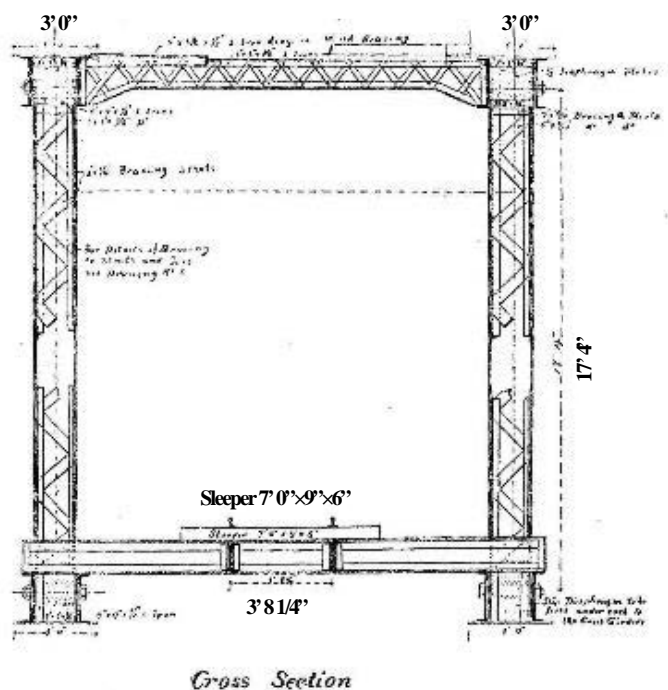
“I. G. R. GIRDERS FOR 200FT SPANS DRAWING No. 1”
